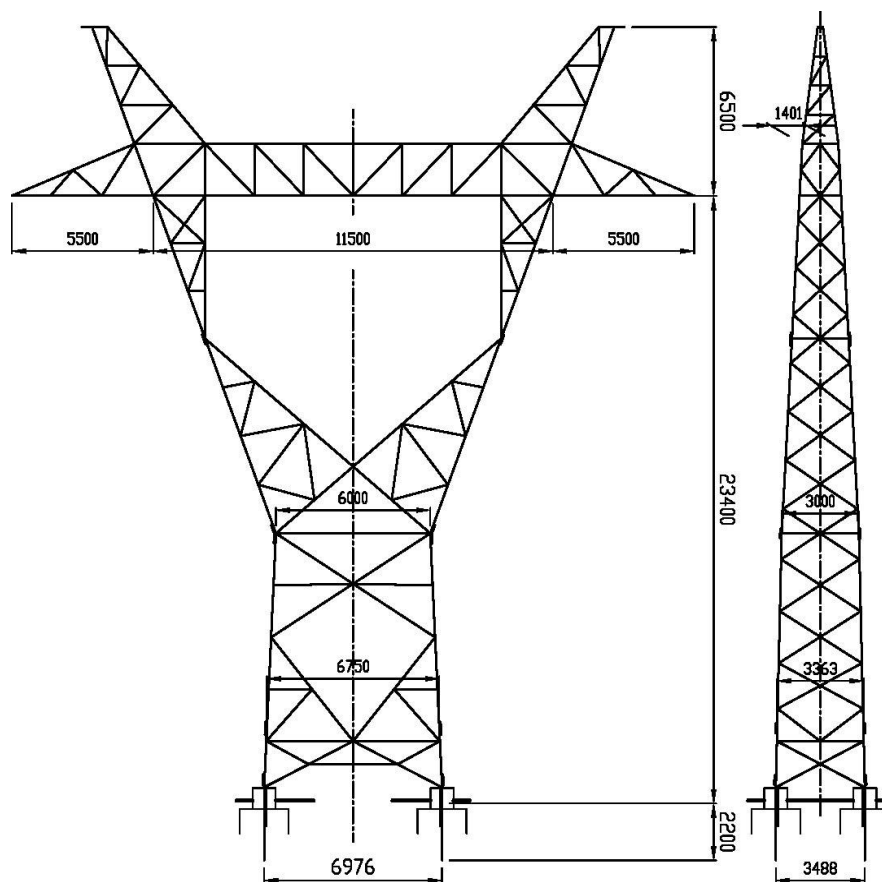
Kotevní stožár Soudek 2x220 kV
